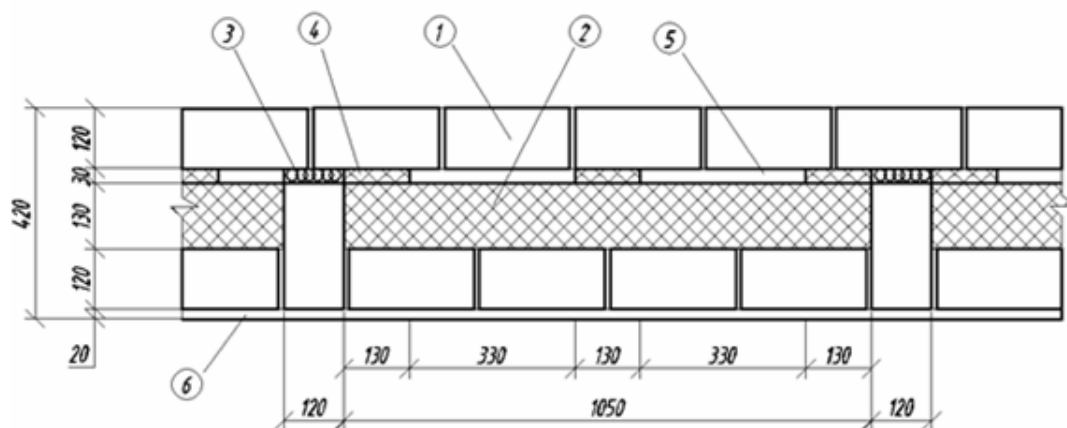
Поперечное сечение конструкции стены облегченной кирпичной кладки:
